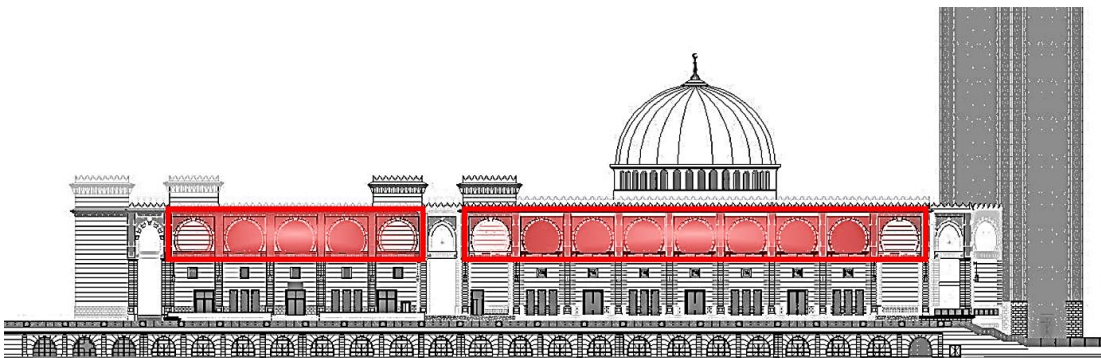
4. La dominance des arcs outrepassé sur la façade Sud. (Source : auteur)
